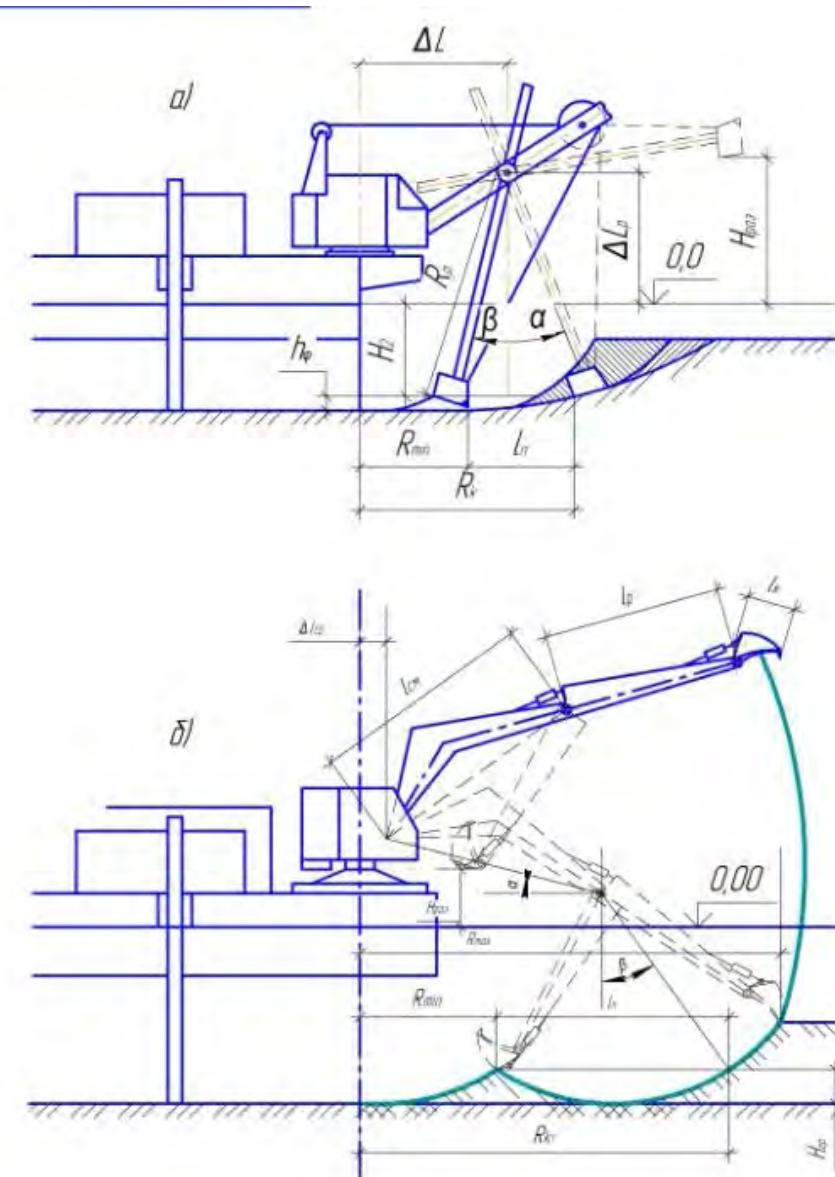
Схема разработки грунта штанговыми земснарядами
